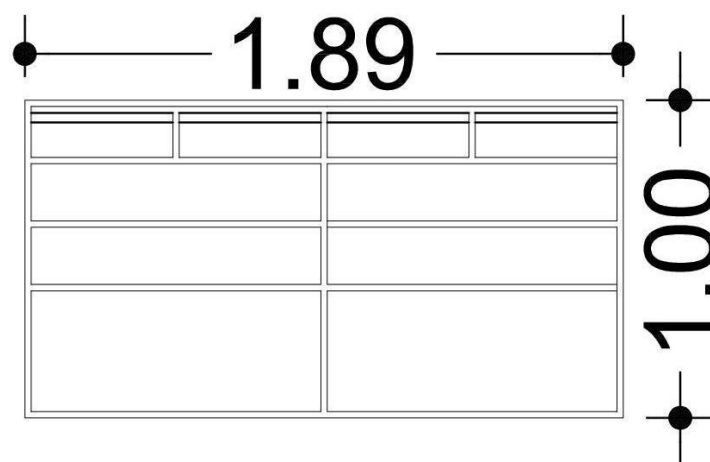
Plantas baixas e vistas (Vista da parede do fundo e os armários e prateleiras)
